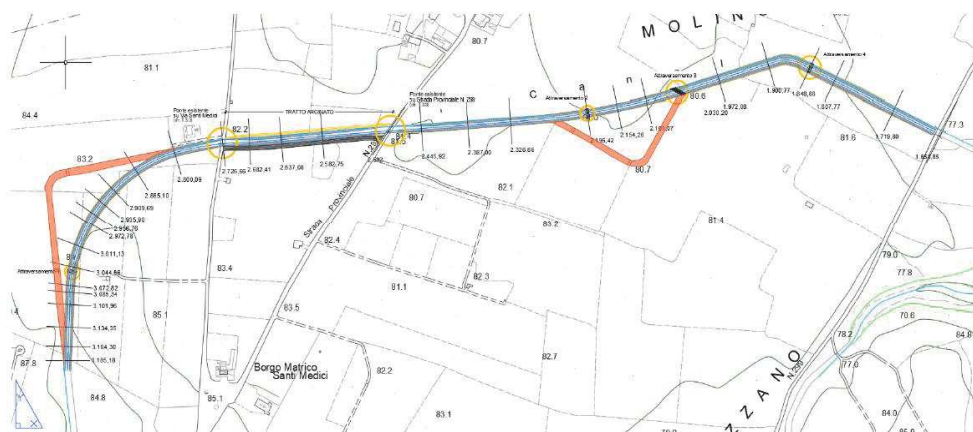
Stralcio planimetrico interventi di progetto sul Canale Minervino in agro di Uggiano.
